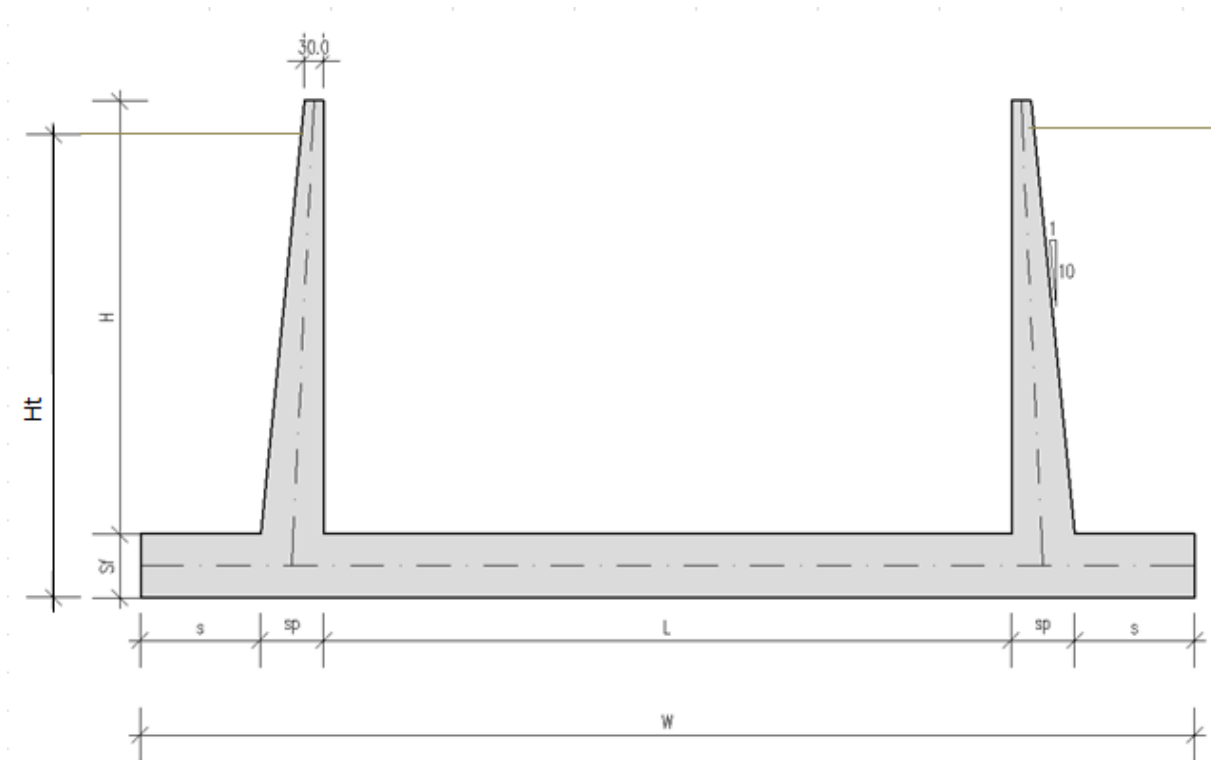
1 – GEOMETRIA DELLA SEZIONE DEL MURO AD U
